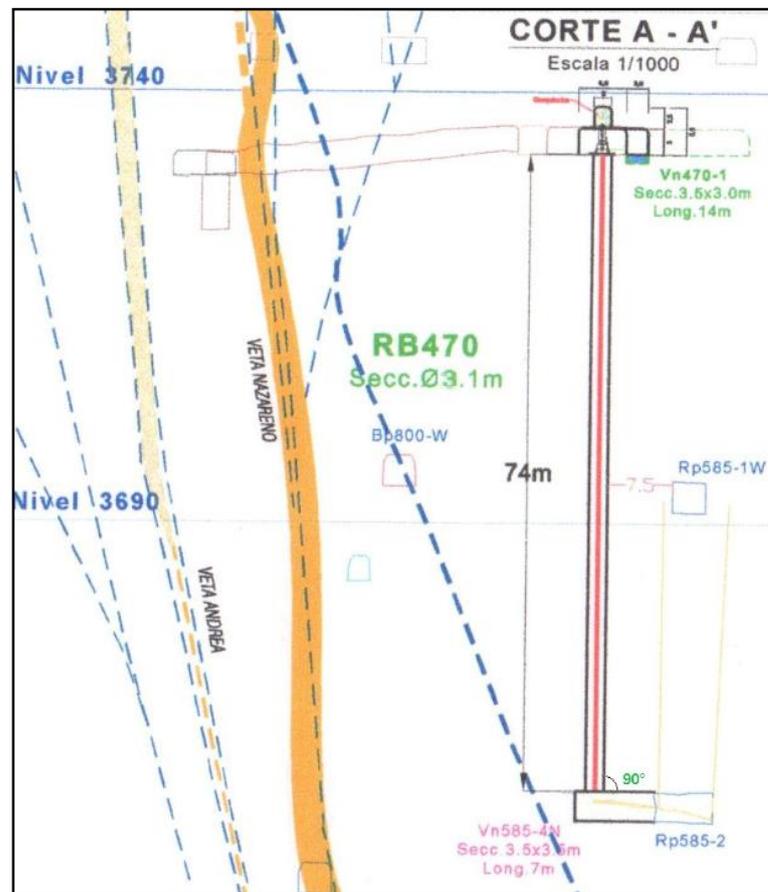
2 Proyecto de Chimenea RB 470, vista en perfil, corte A-A´
